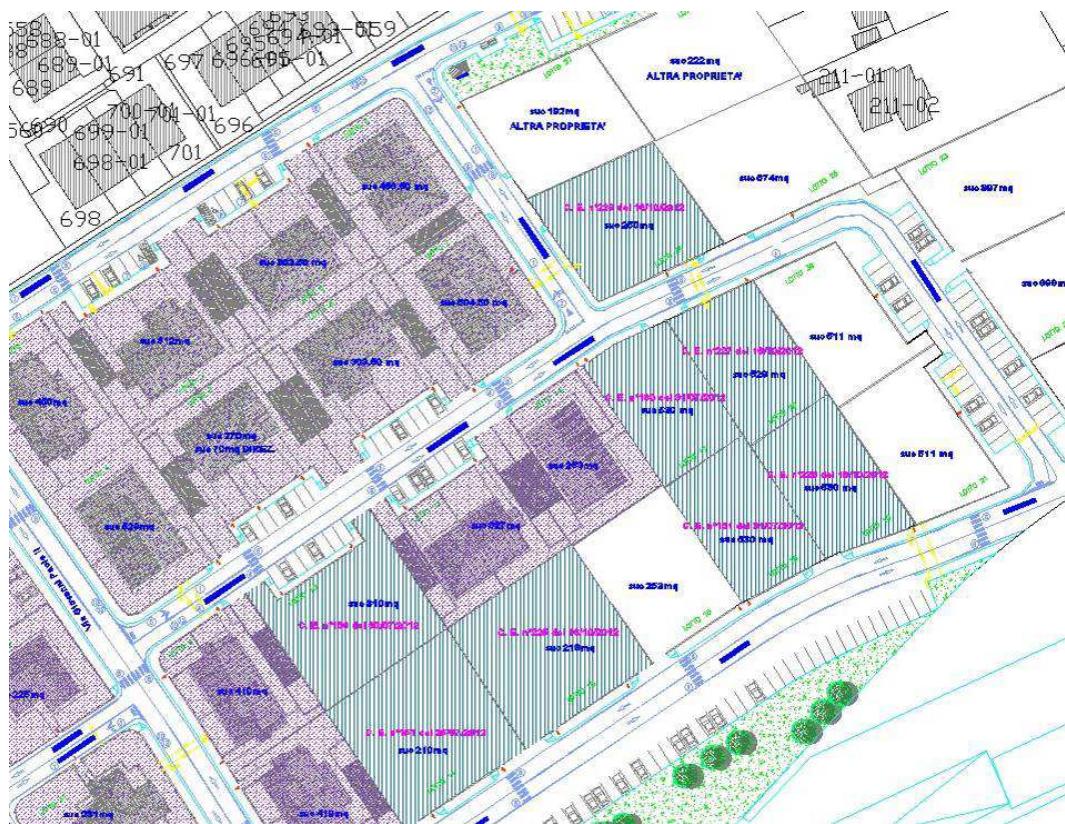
Planimetria generale dello Stato Attuale – Zoom B –
